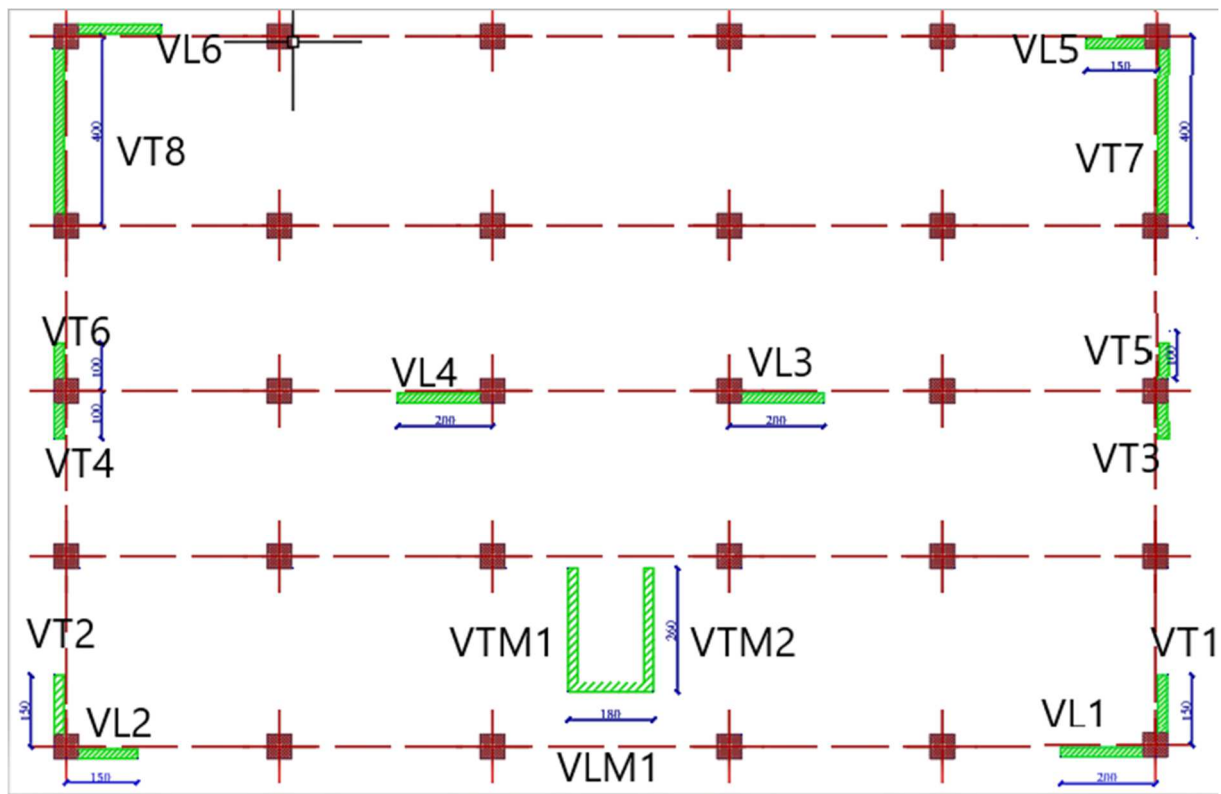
Schéma de la disposition des poteaux et des voiles
